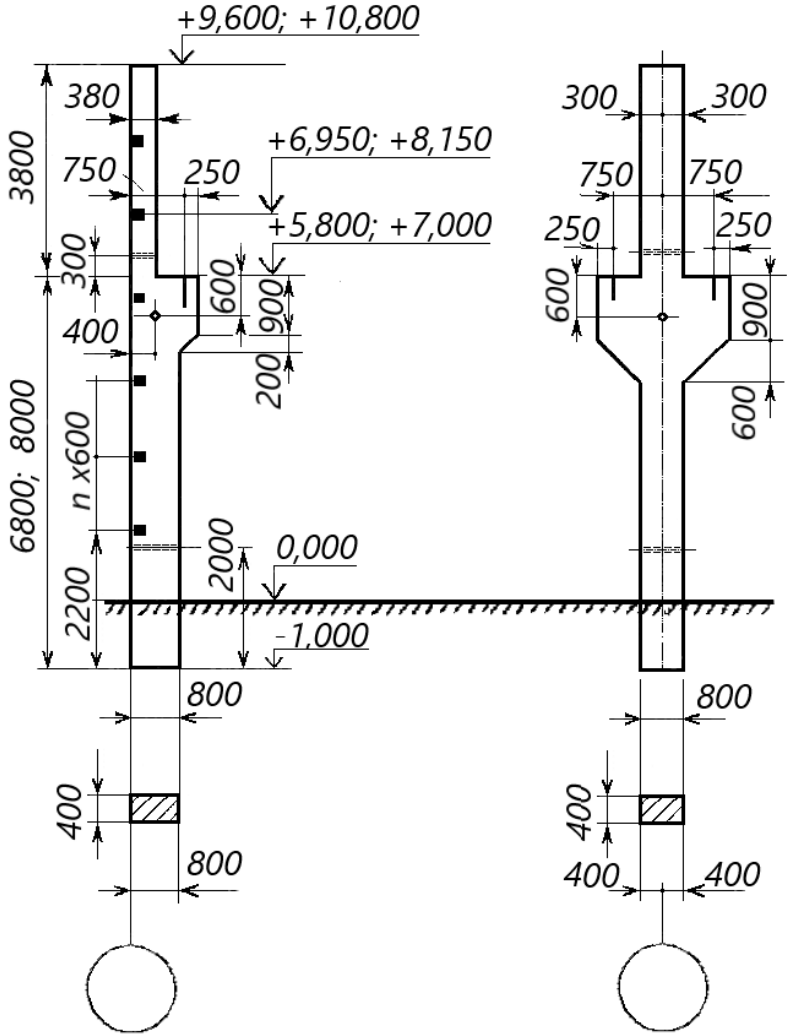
Типові колони для будівель висотою 9,6 м або 10,8 м з кранами вантажністю 100 кН або 200/50 кН, прольотами 18 м або 24 м, з кроком колон 6 м
